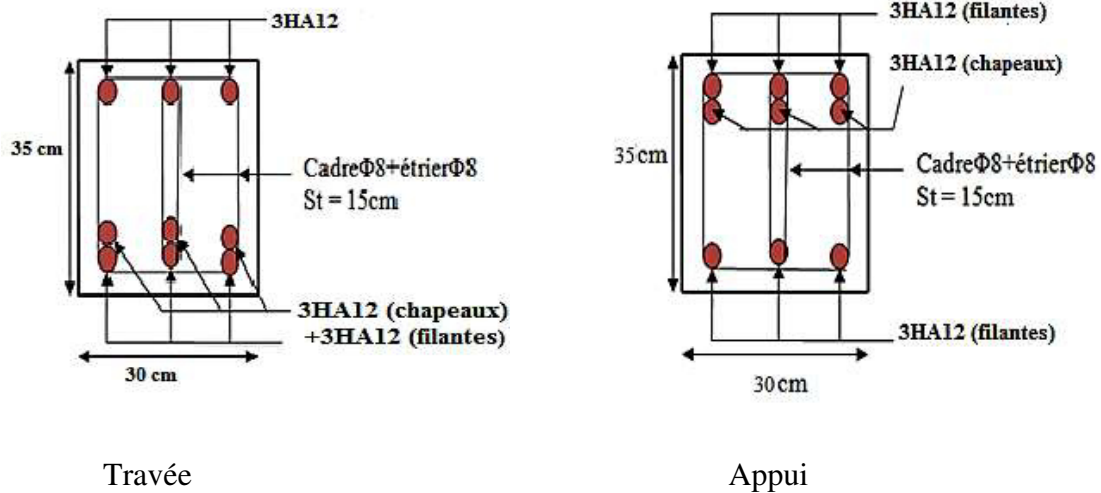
Schéma de ferrailage des poutres secondaires des Etages 8 – 9.
